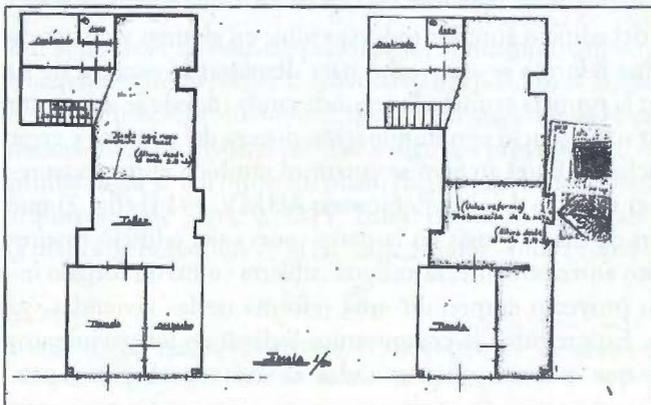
Plano de proyecto de construcción de un altillo en 1961 (AHMV, 1961).
